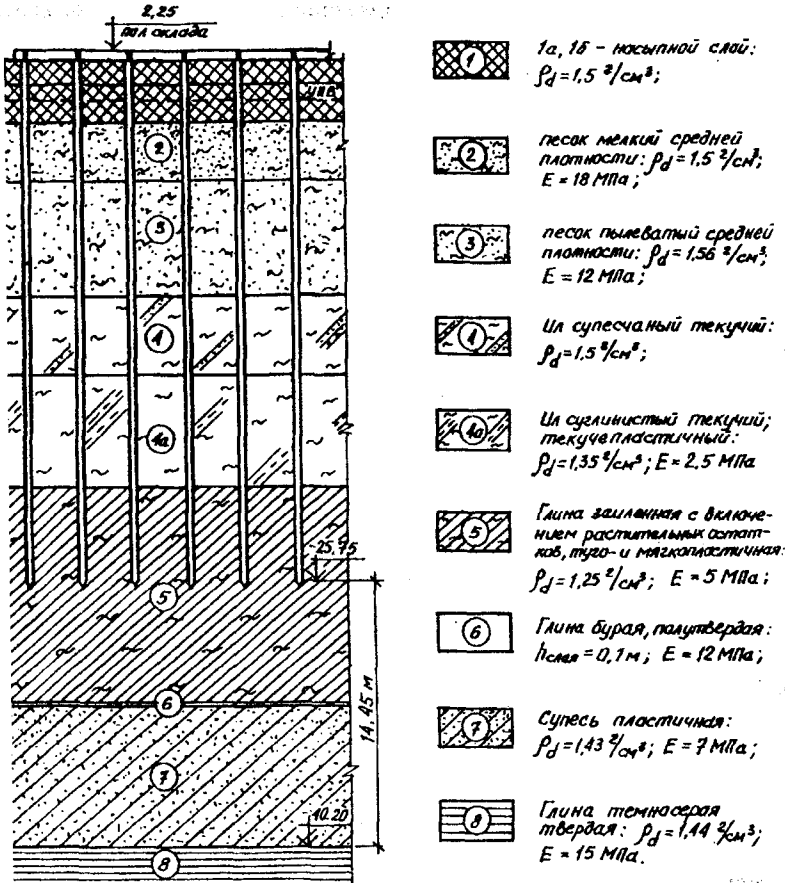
Инженерно-геологический разрез стройплощадки и схемы вариантов свайного фундирования
